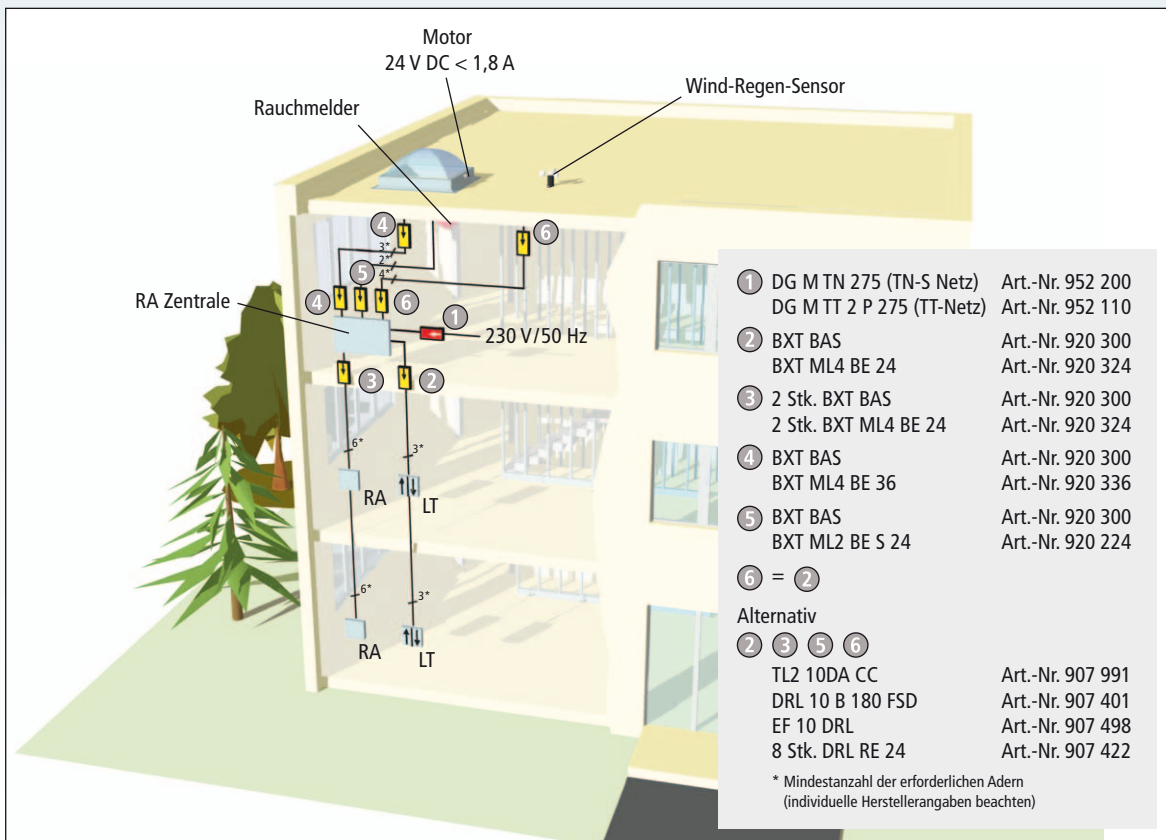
Lichtkuppel auf einem nichtmetallinen Dach einer baulichen Anlage ohne Äußeren Blitzschutz
